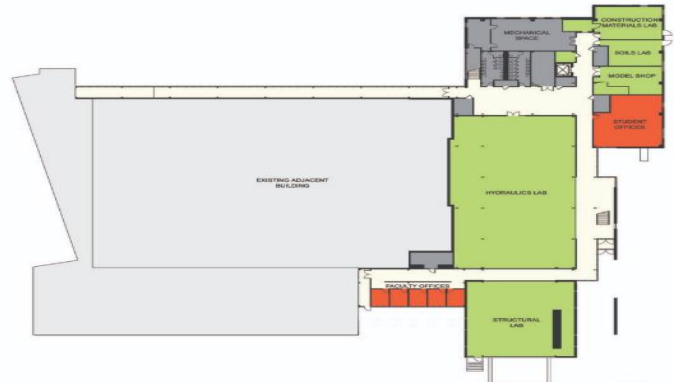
Plan de RDC de Swenson Civil Engineering Building
